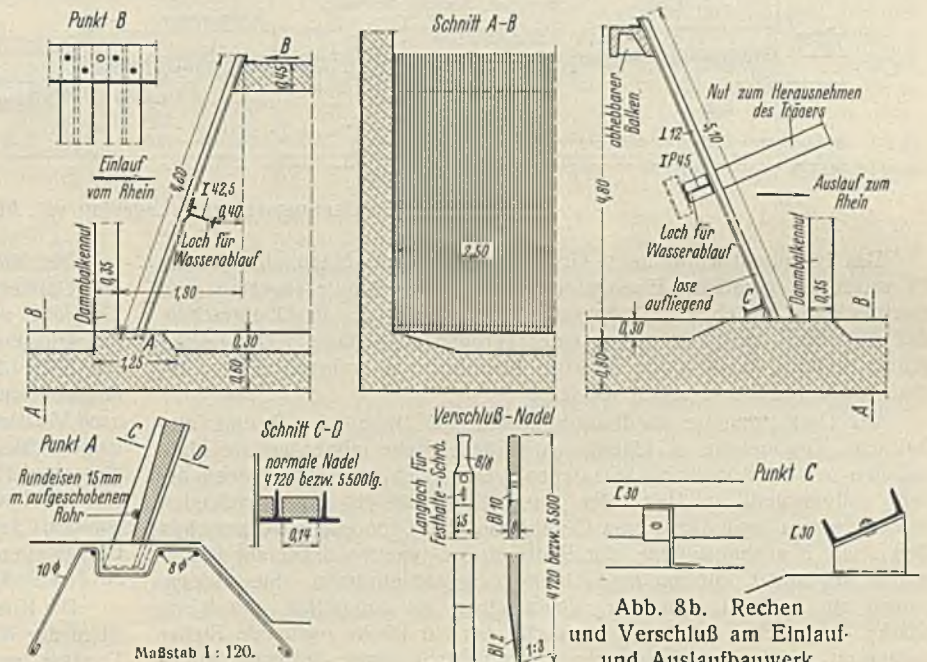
Rechen und Verschluss am Einlauf- und Auslaufbauwerk.
